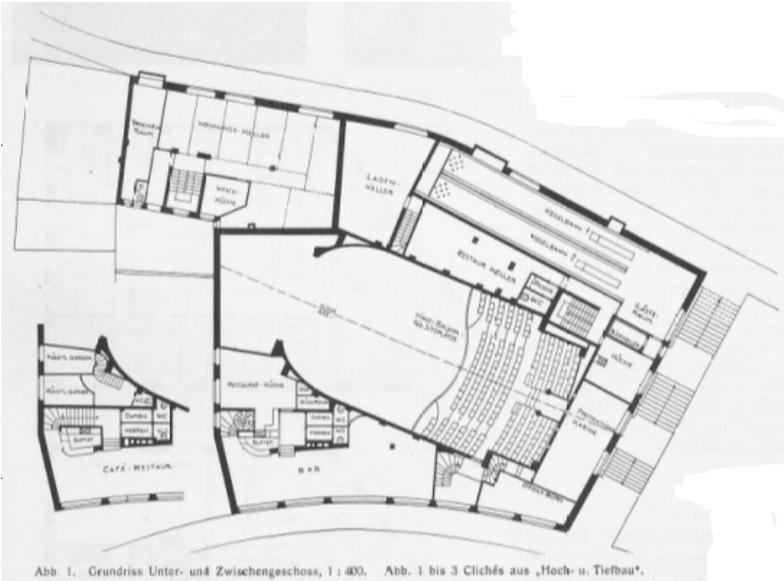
Grundriss Unter- und Zwischengeschoss, 1:400. Abb. 1 bis 3 Clichés aus „Hoch- u. Tiefbau“.
